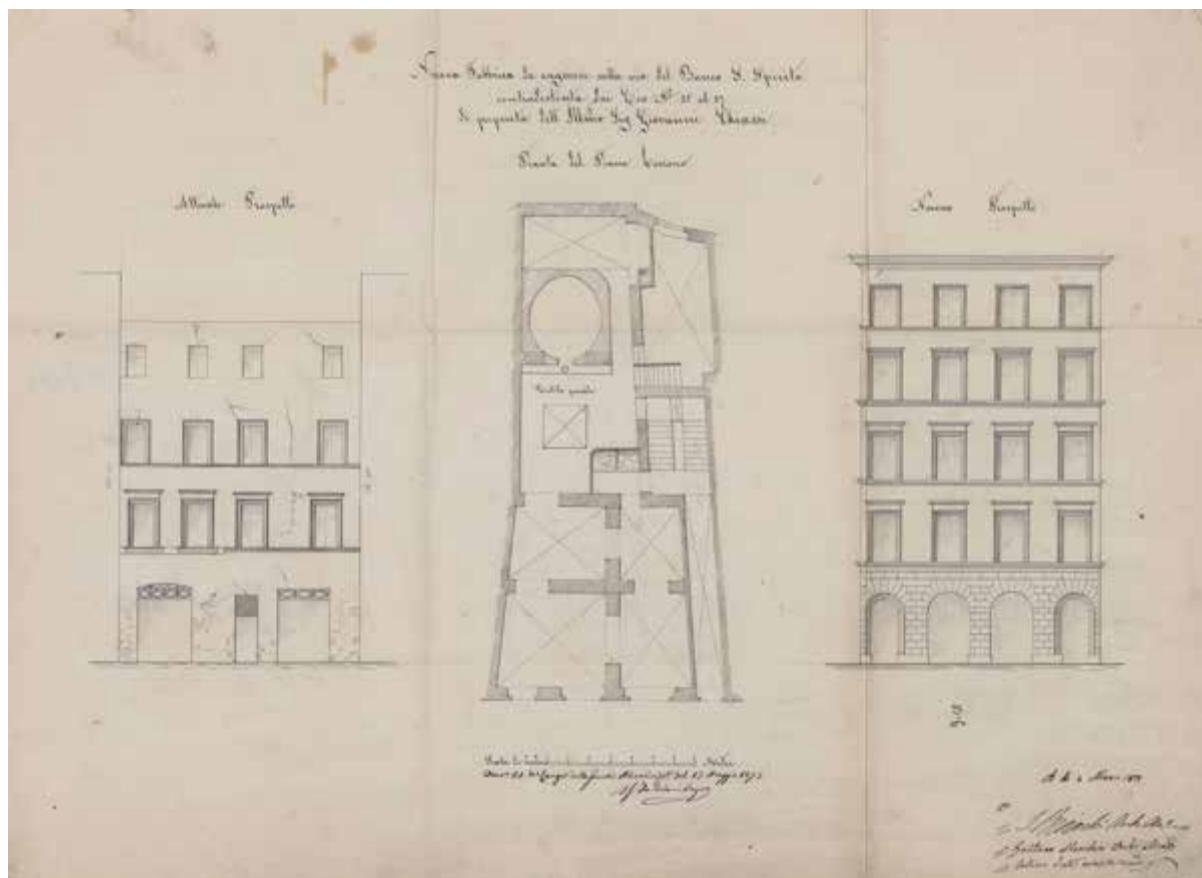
Anonimo, planimetria del primo piano e progetto di sopraelevazione e di restauro del prospetto dell'abitazione posta in via del Banco di Santo Spirito 35-37, disegno. ASCR, Titolo 54, protocollo 13161/1872.
